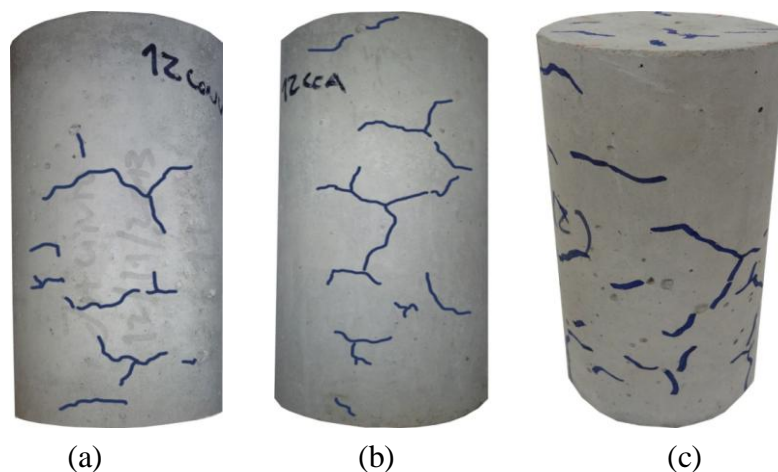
Fissuração superficial após exposição a 600°C (a) concreto convencional (b) concreto com CCA amorfa (c) concreto com CCA parcialmente cristalina
